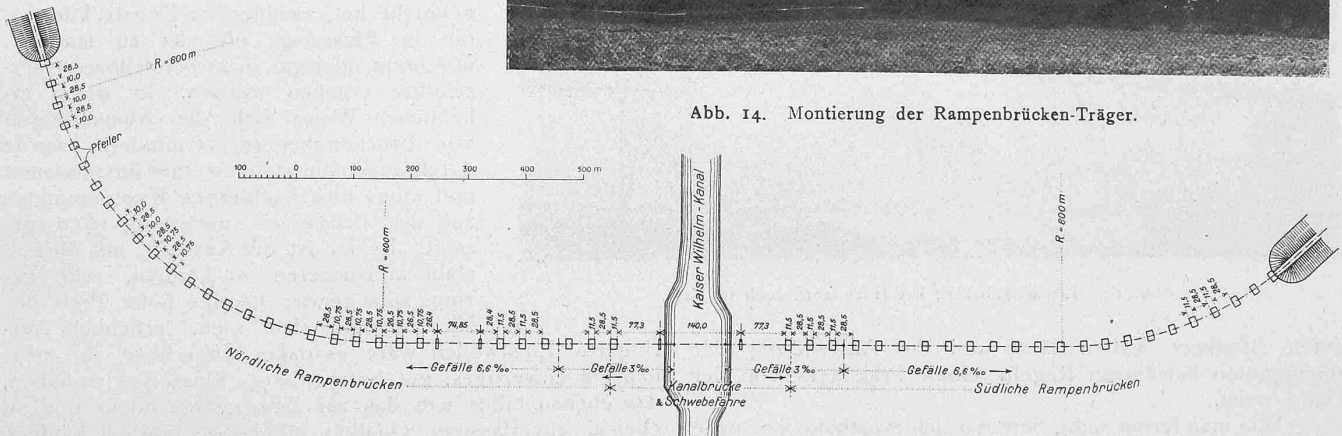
Eisenbahnbrücke über den Kaiser Wilhelm-Kanal bei Rendsburg. — Lageplan 1:12000.
